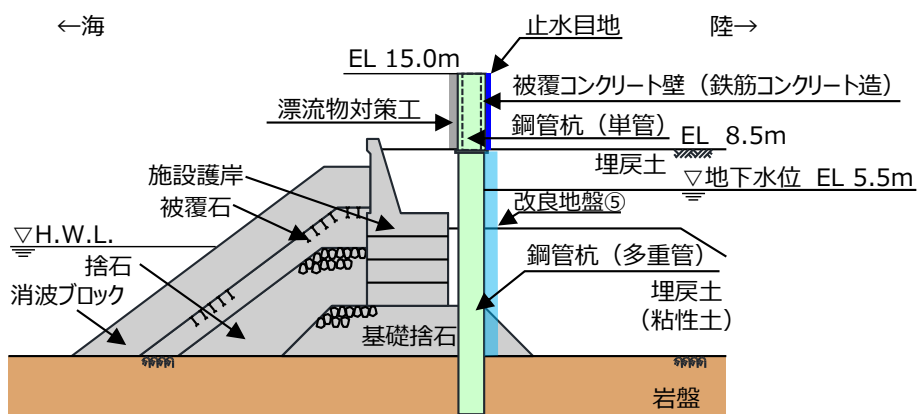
防波壁（多重鋼管杭式擁壁）の構造概要図（断面図）
